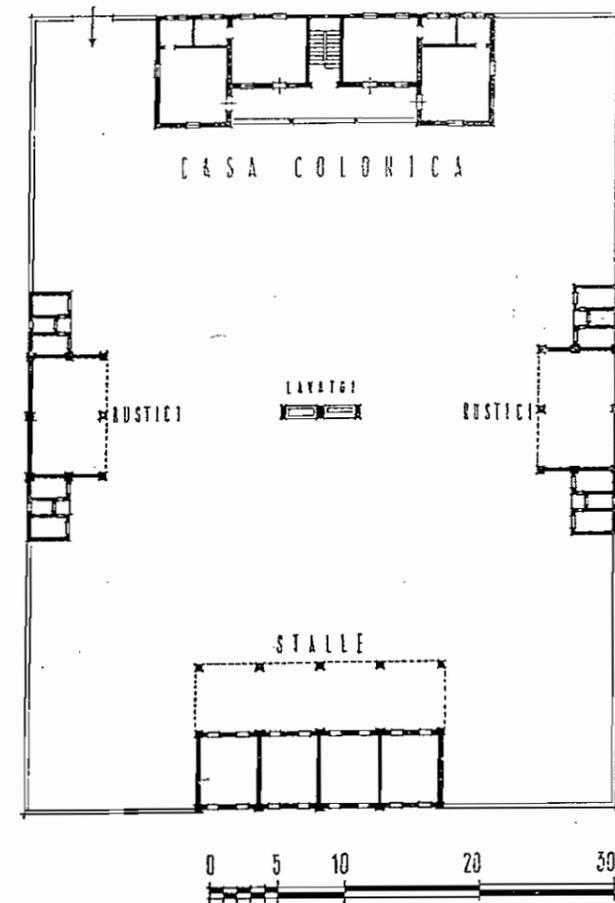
Planimetria generale di una corte colonica per quattro famiglie dell'Alto Milanese e della Brianza.
